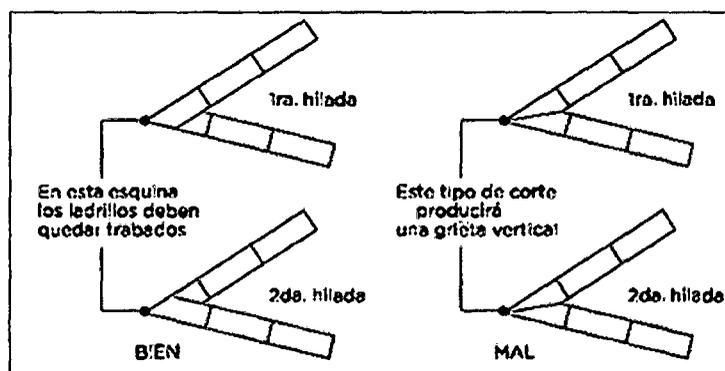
Incorrecto endentado de muro en ángulos no rectos
